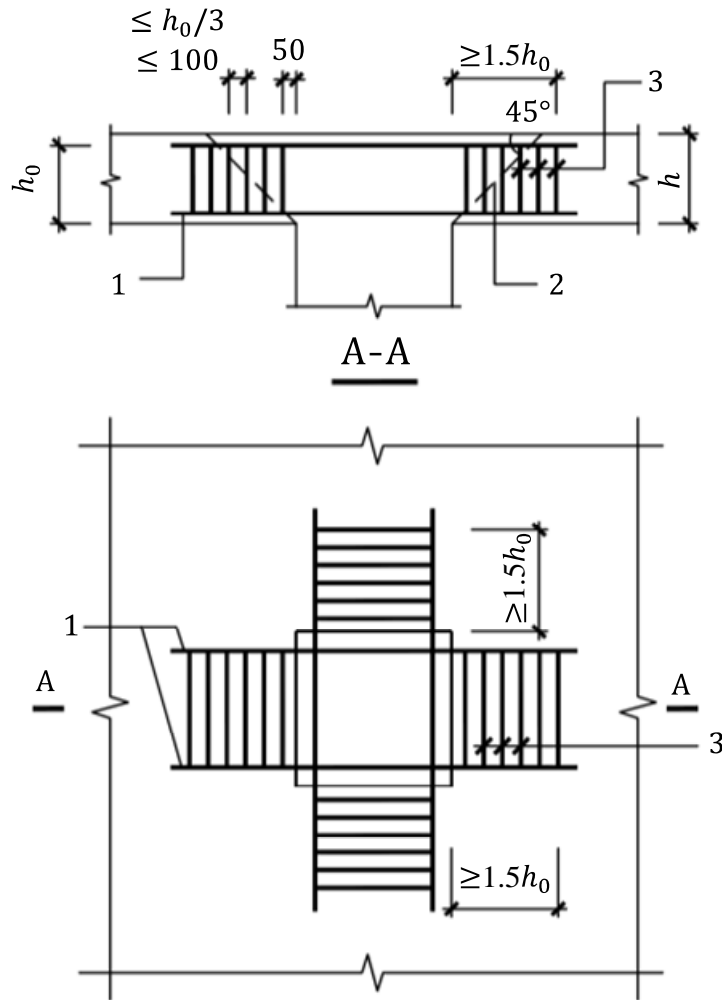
板中箍筋作抗冲切钢筋布置示意
